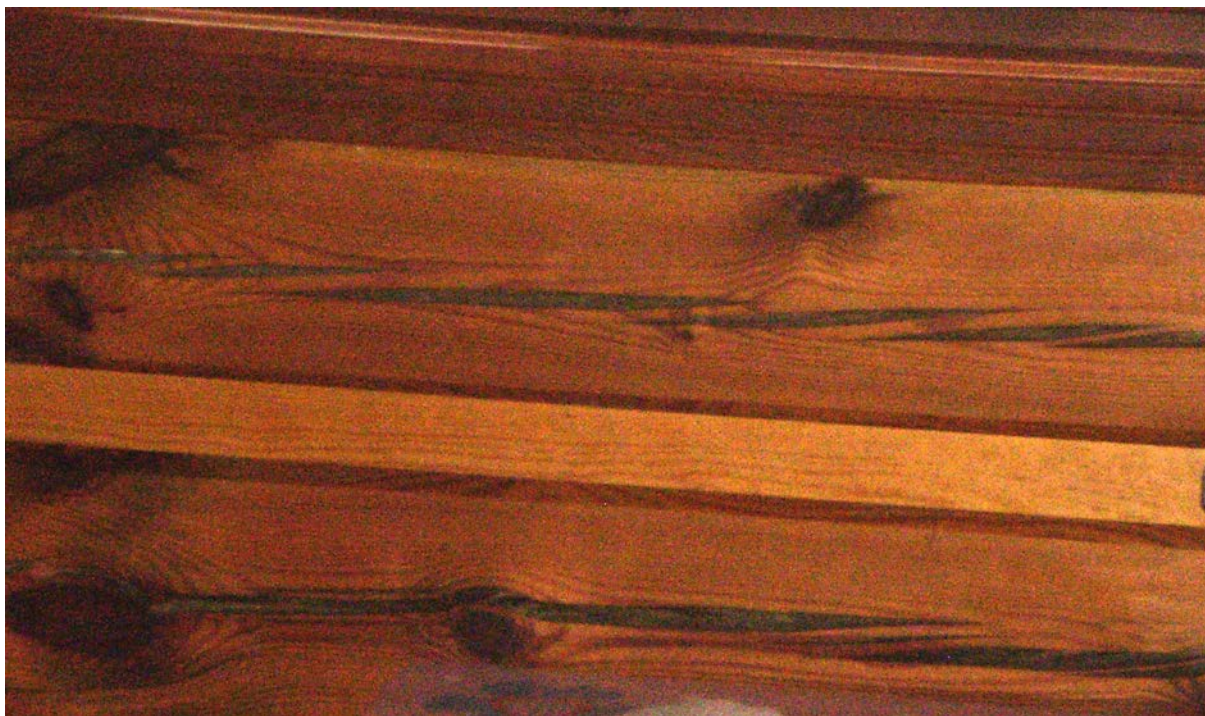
Zamodralost dřevěných prvků konstrukce a dodatečné zaizolování rohových spojů konstrukce PUR pěnou[5]
